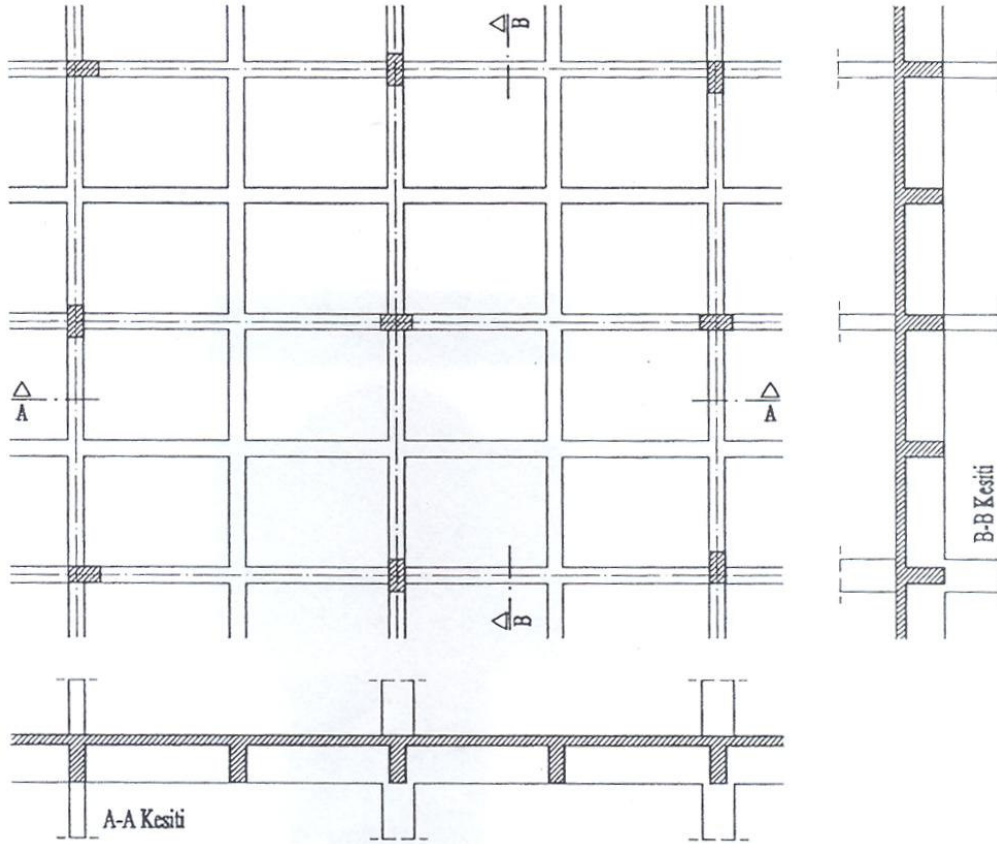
Tek doğrultuda çalışan kirişli plak döşeme
